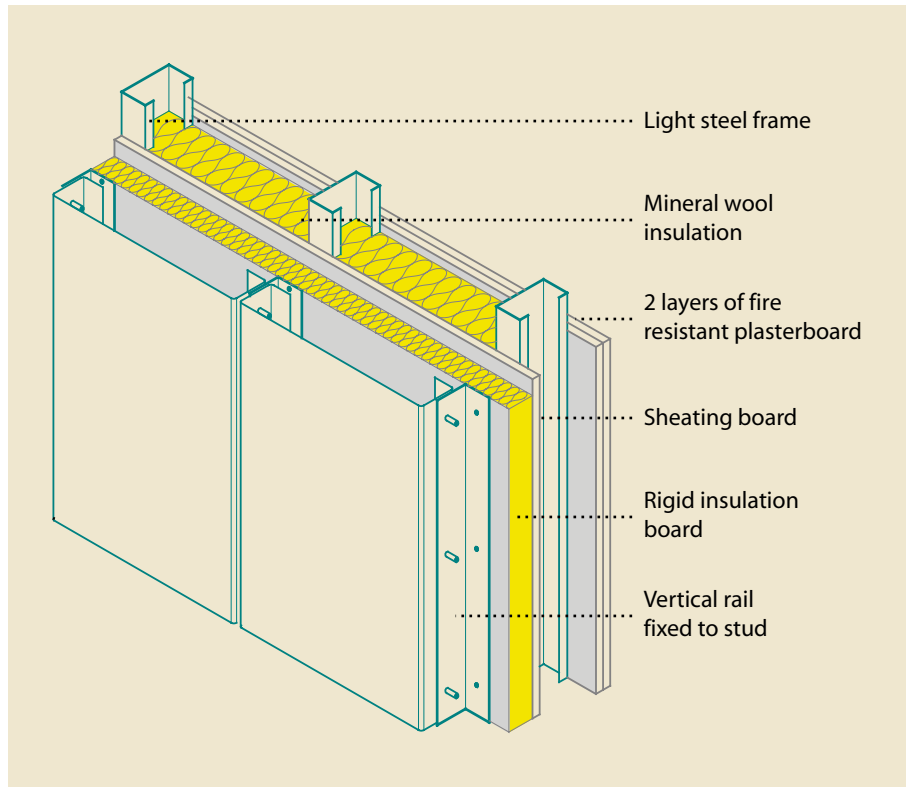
Panel de fachada exterior con cerramiento metálico
